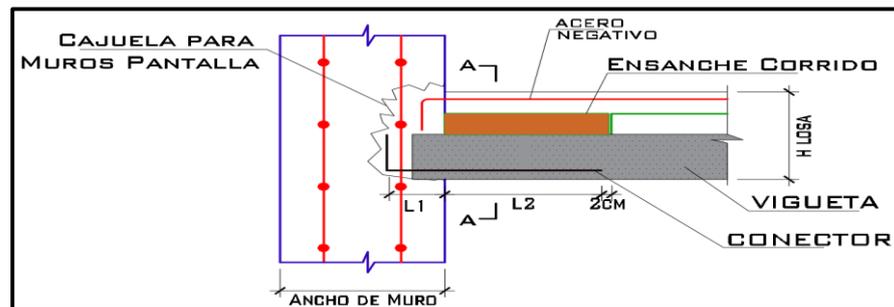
Detalle de ingreso de vigueta a muro con refuerzo.
